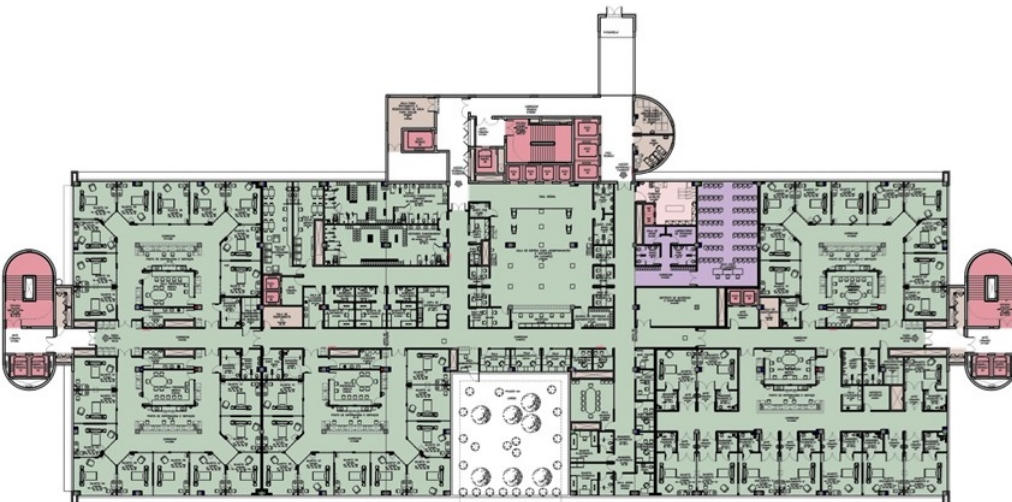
Anexo I - planta baixa do 6° pavimento. (Fonte: material de divulgação projeto de ampliação HCPA)
